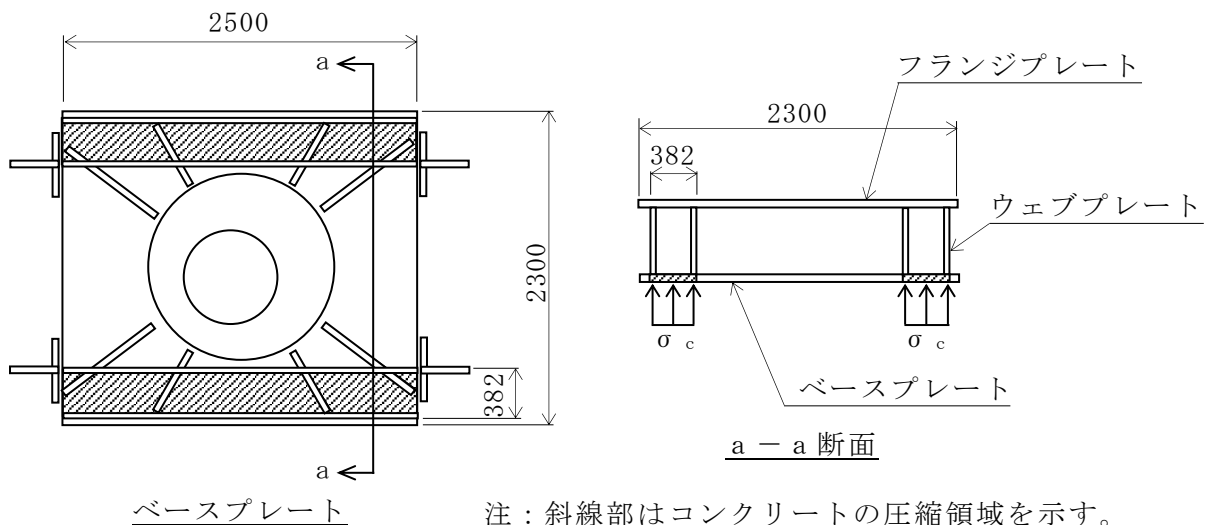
コンクリートに作用する圧縮力の概要図 (単位: mm)
